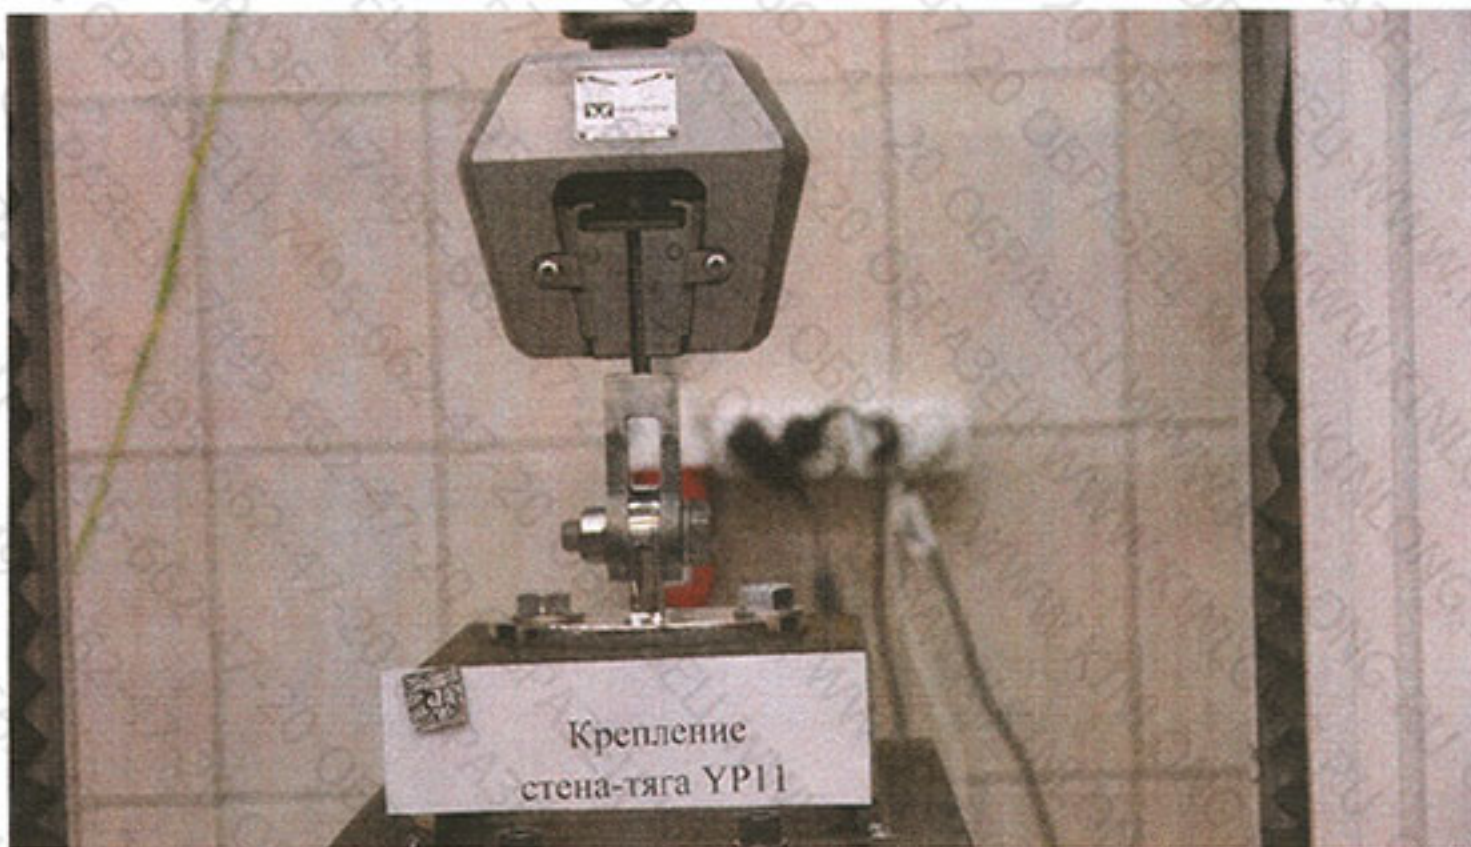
Образец в процессе испытания. Схема нагружения (Fy)
